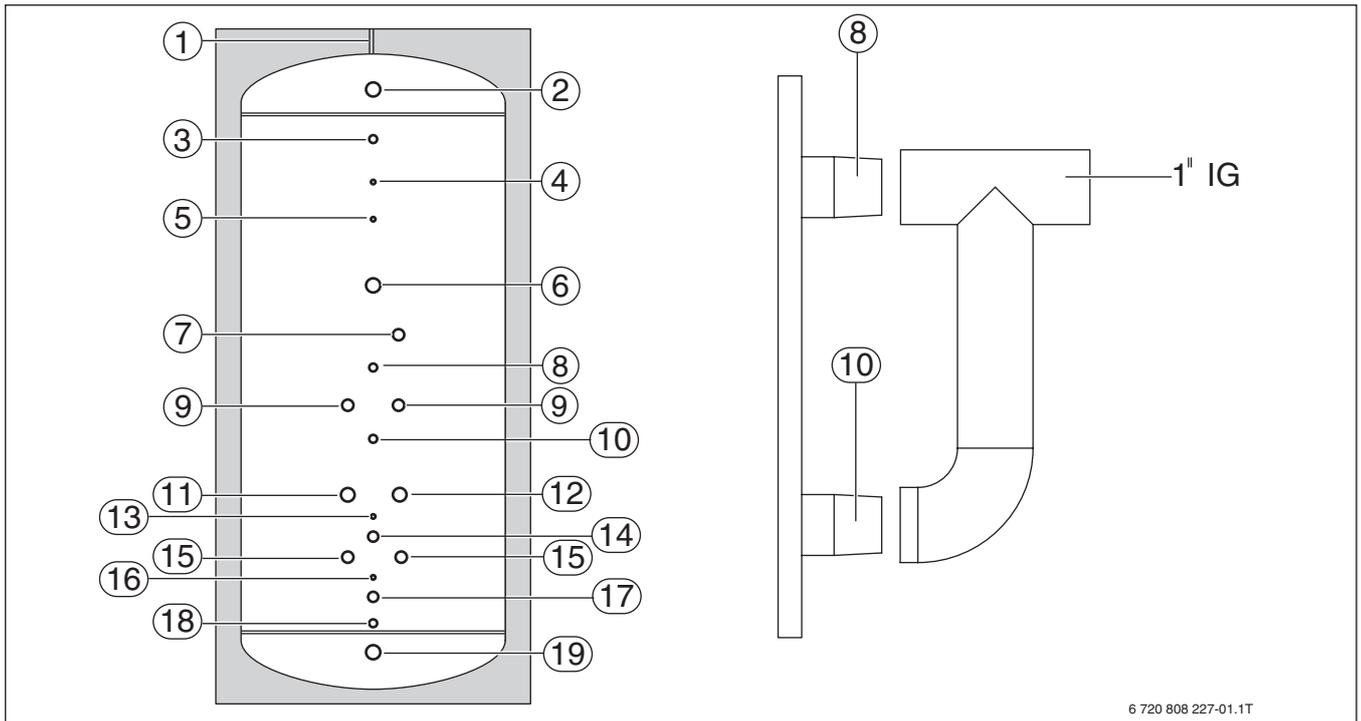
Anschlüsse mit Abmessungen KNW ... EW/C
